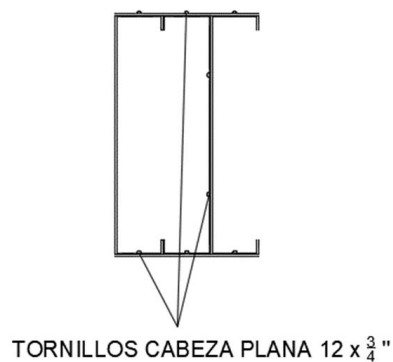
Detalle de la conexión viga-canal-solera, por los autores, 2020.
